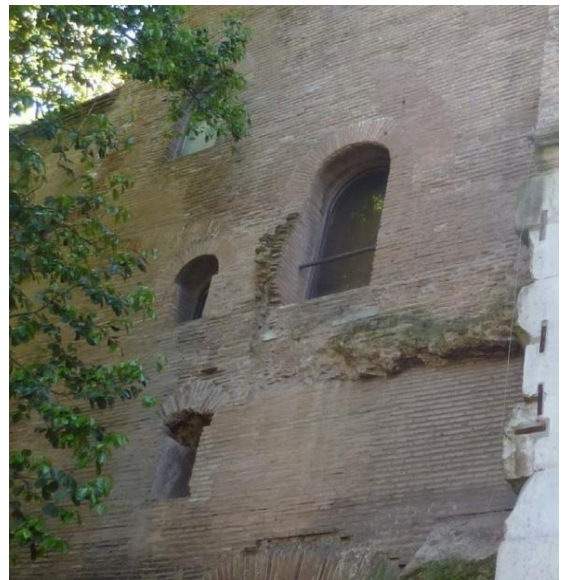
Porta Appia, prospetto nord. Si notano le tracce dell'ingresso collegato alle rampe del braccio orientale della controporta. Foto D'Ippolito.
